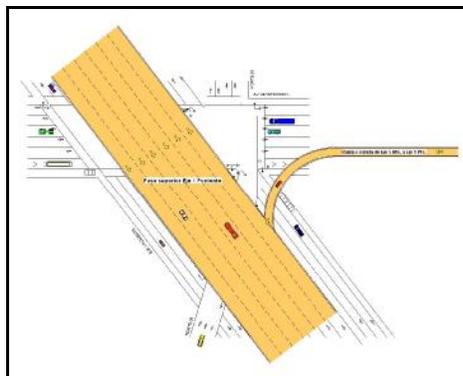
Detalle en el puente propuesto de Eje 1 Poniente y Eje 5 Norte (intersección 2)
